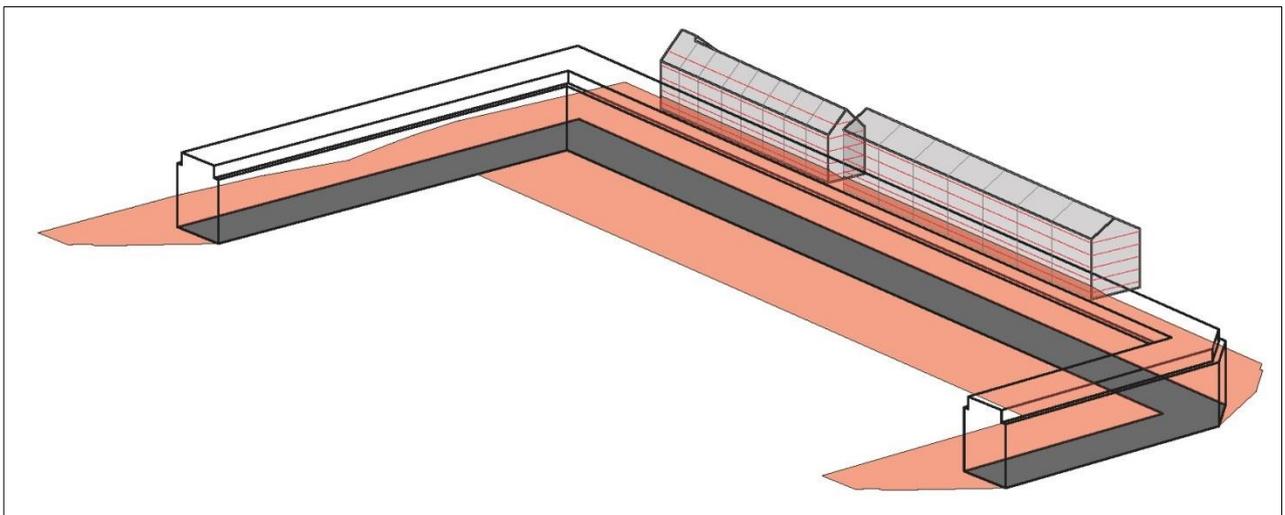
Ansicht Gebäude BBB und EBG an der Lehenmattstrasse: 2 Stunden-Schatten einer grundzonenkonformen Regelbebauung (rot).
